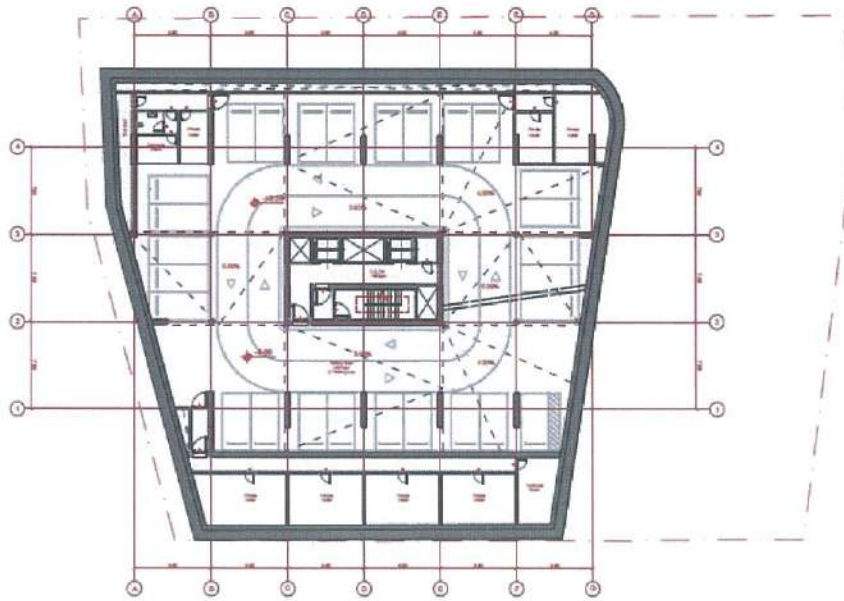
Planimetria e katit -3, në kuotën -10.28 SIP 1 515 m²
